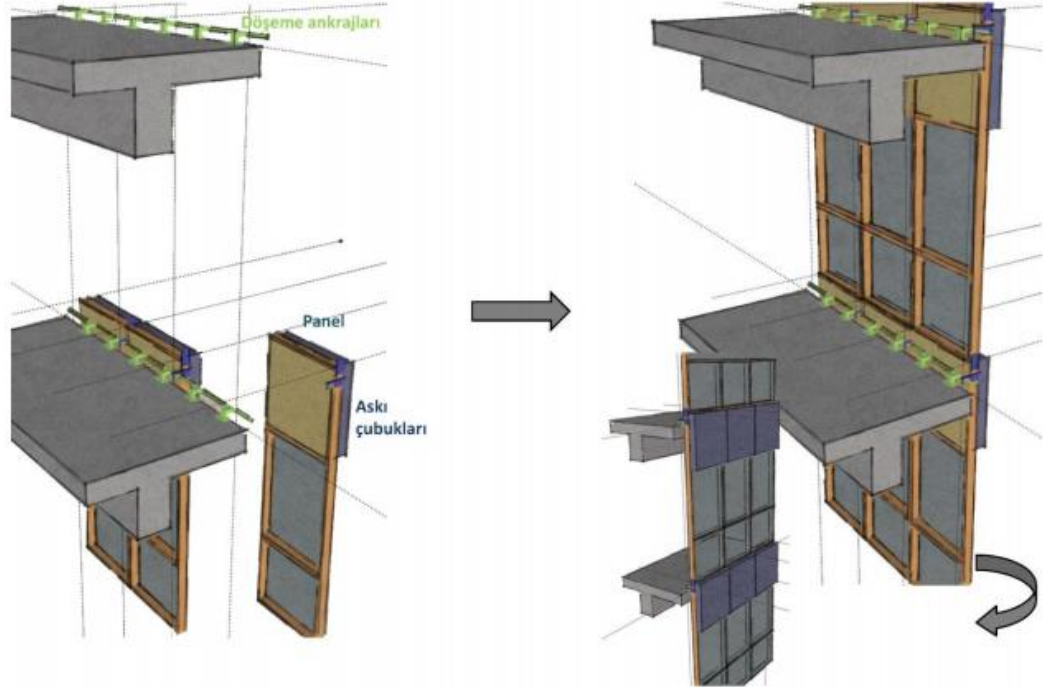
Yarı panel sistem montaj detayı[29]
